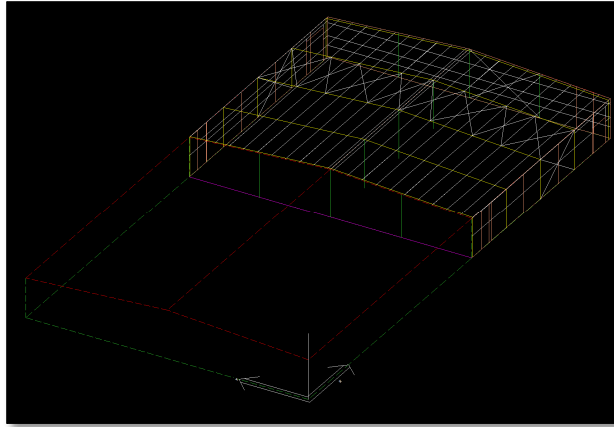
Selección de los largueros de cubierta y muros del proyecto de expansión en el software estructural
